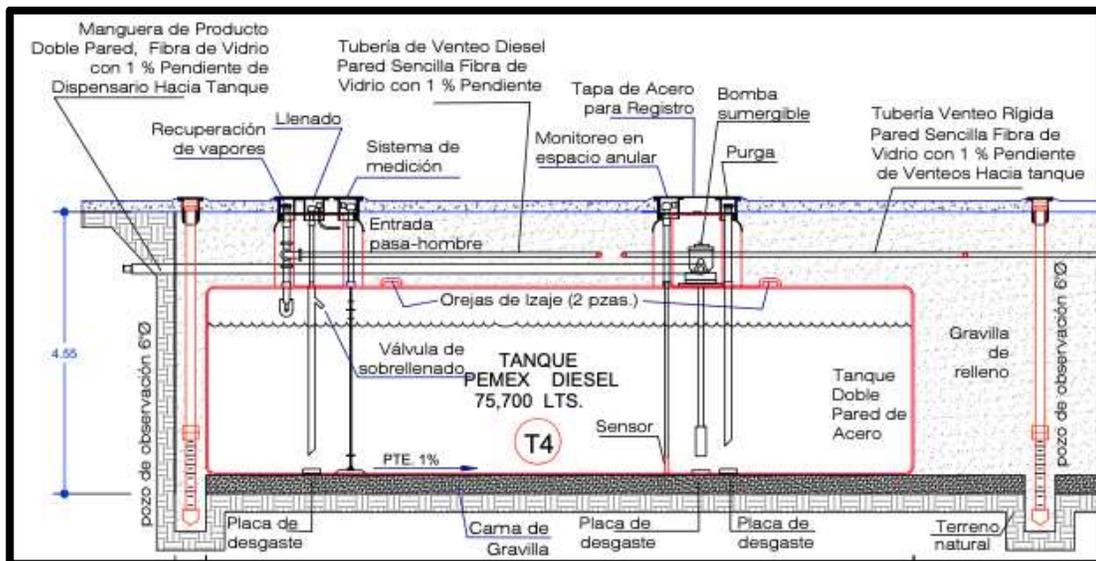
Sección de excavación para tanques (Plano M-1.3).
